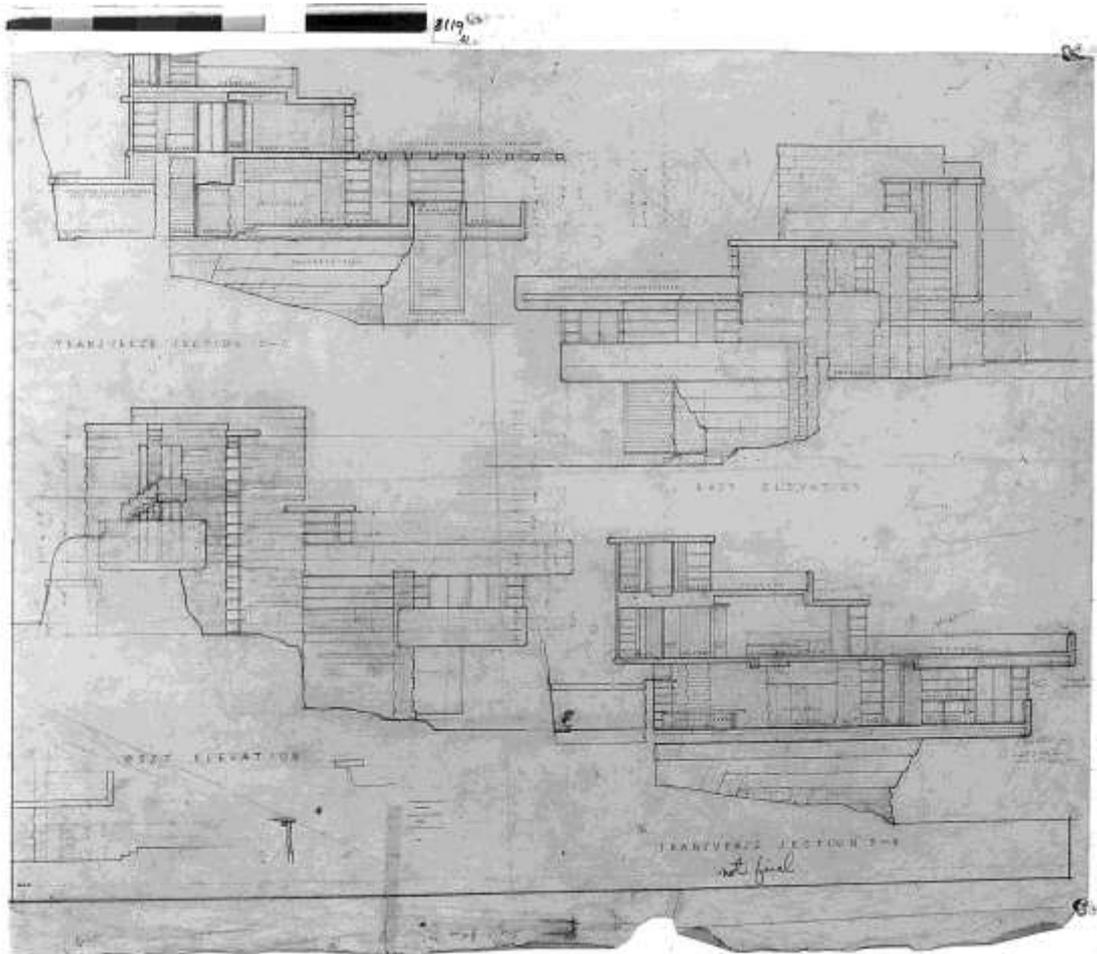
«transverse section /east elevation /west elevation /transverse section/ not final » Coupes B-B et A-A
